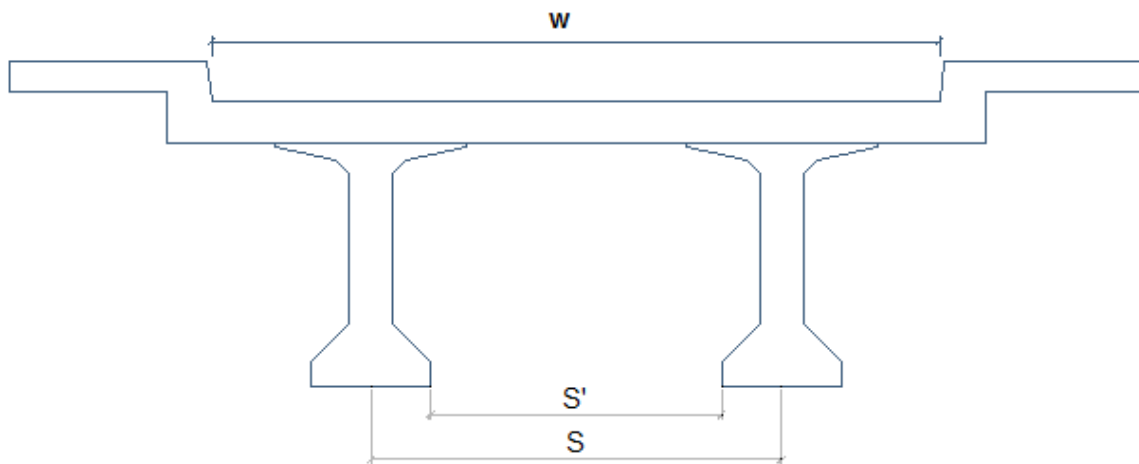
Sección transversal Viga Prefabricada. Fuente: Elaboración propia.
